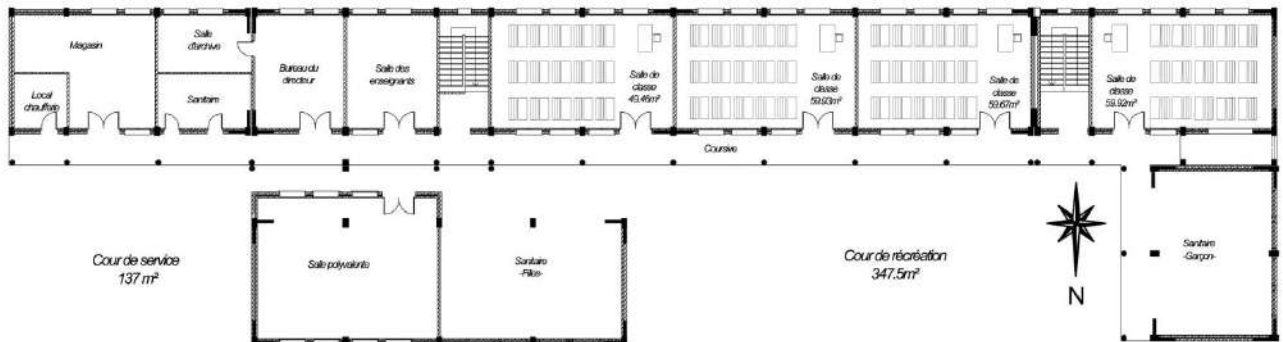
Plan du rez de chaussée de l'école Hafsa.
